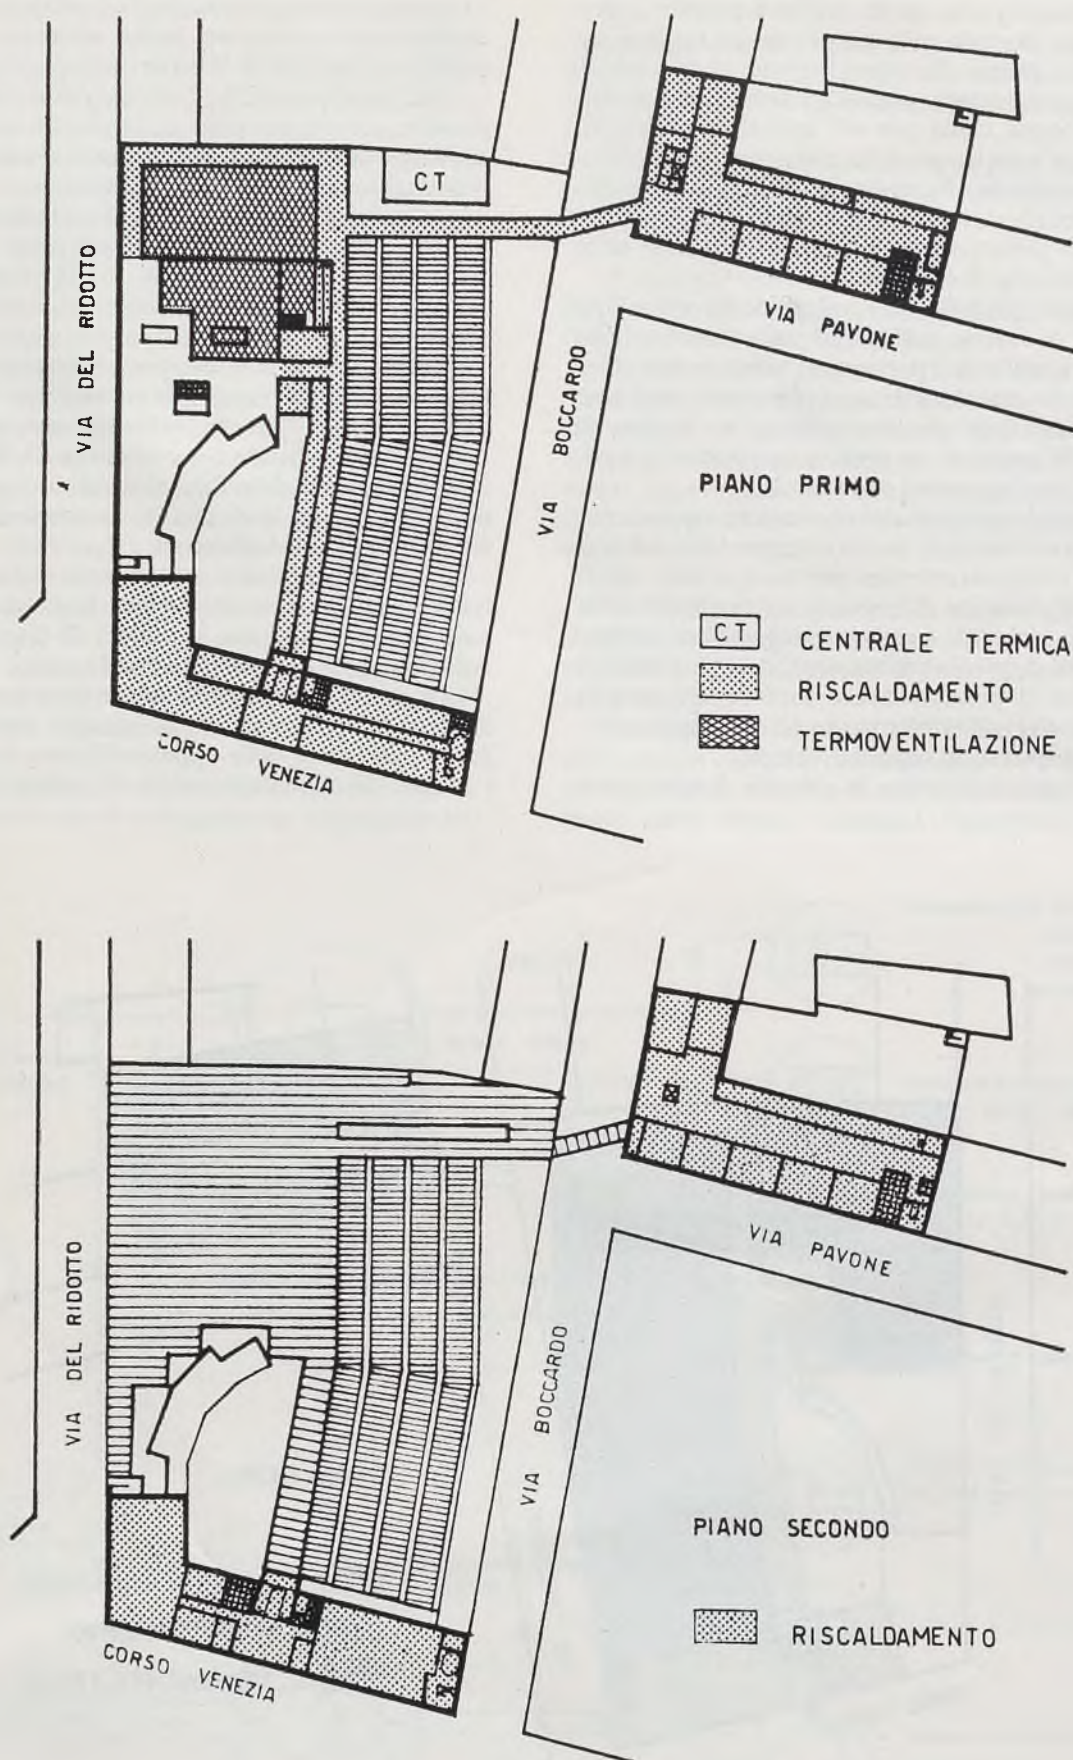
Climatizzazione - Planimetria piani primo e secondo.
